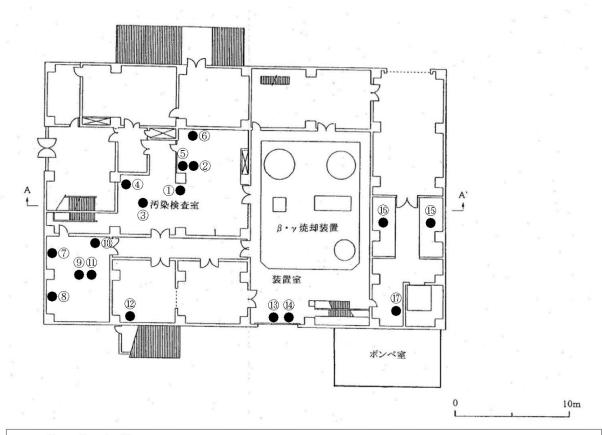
β · γ 固体処理棟 II 平面図及び可燃物配置
